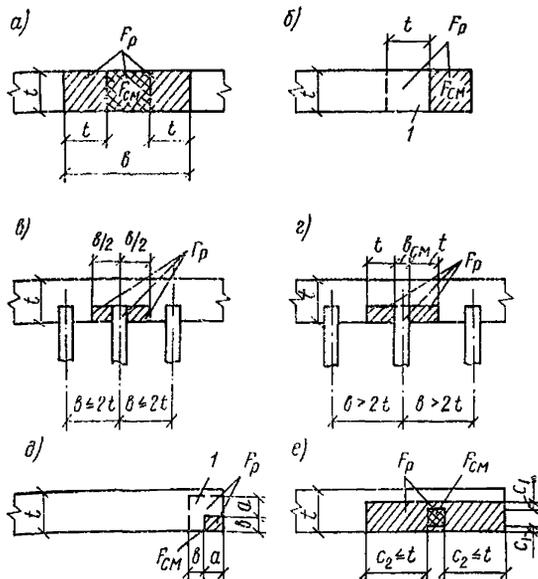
Определение расчетной площади F_p при расчете на местное сжатие
